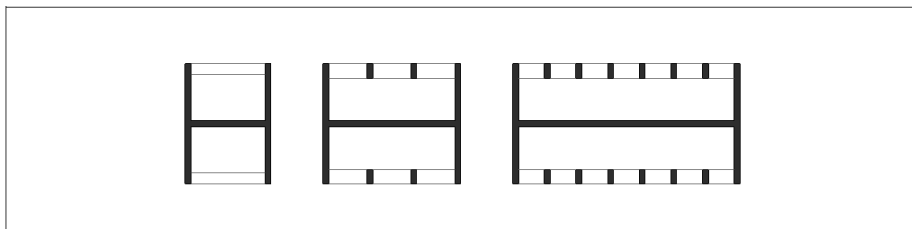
Planta típica de torre bidireccional. Elaboración propia (Roaf, 1988)
